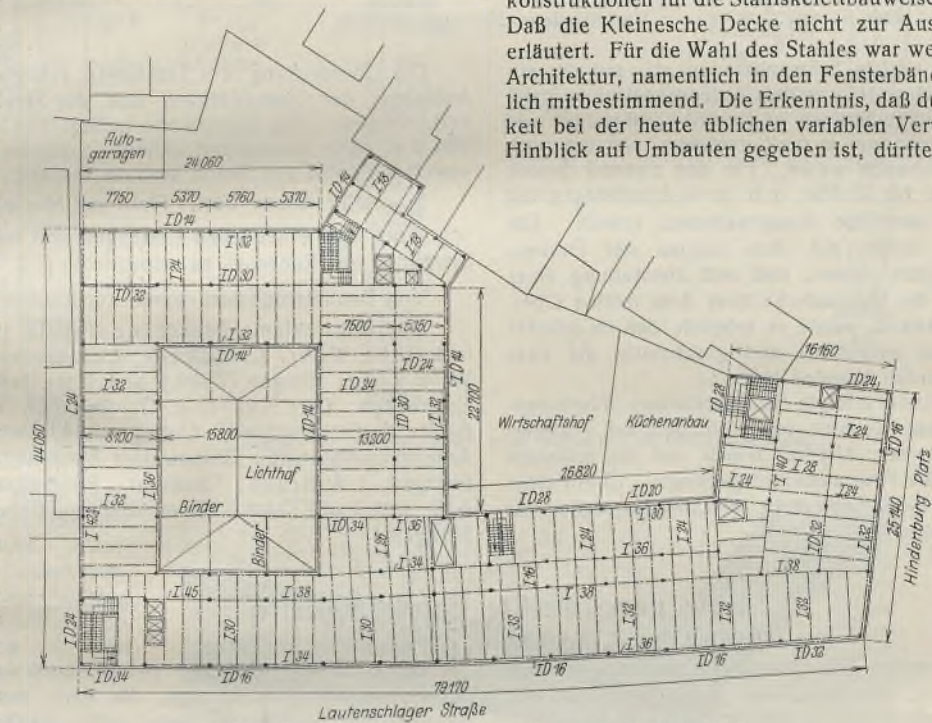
Grundriß und Trägerlagen im Erdgeschoß.
